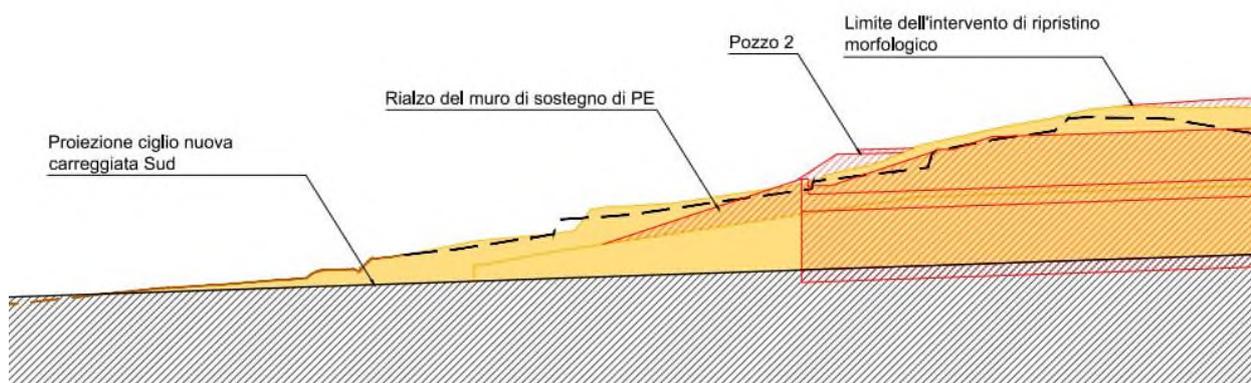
Profilo in asse nuovo imbocco sud galleria artificiale: in tratteggio rosso il tratto con rialzo del muro h 7 m autorizzato (in giallo) nel progetto di ampliamento alla terza corsia
